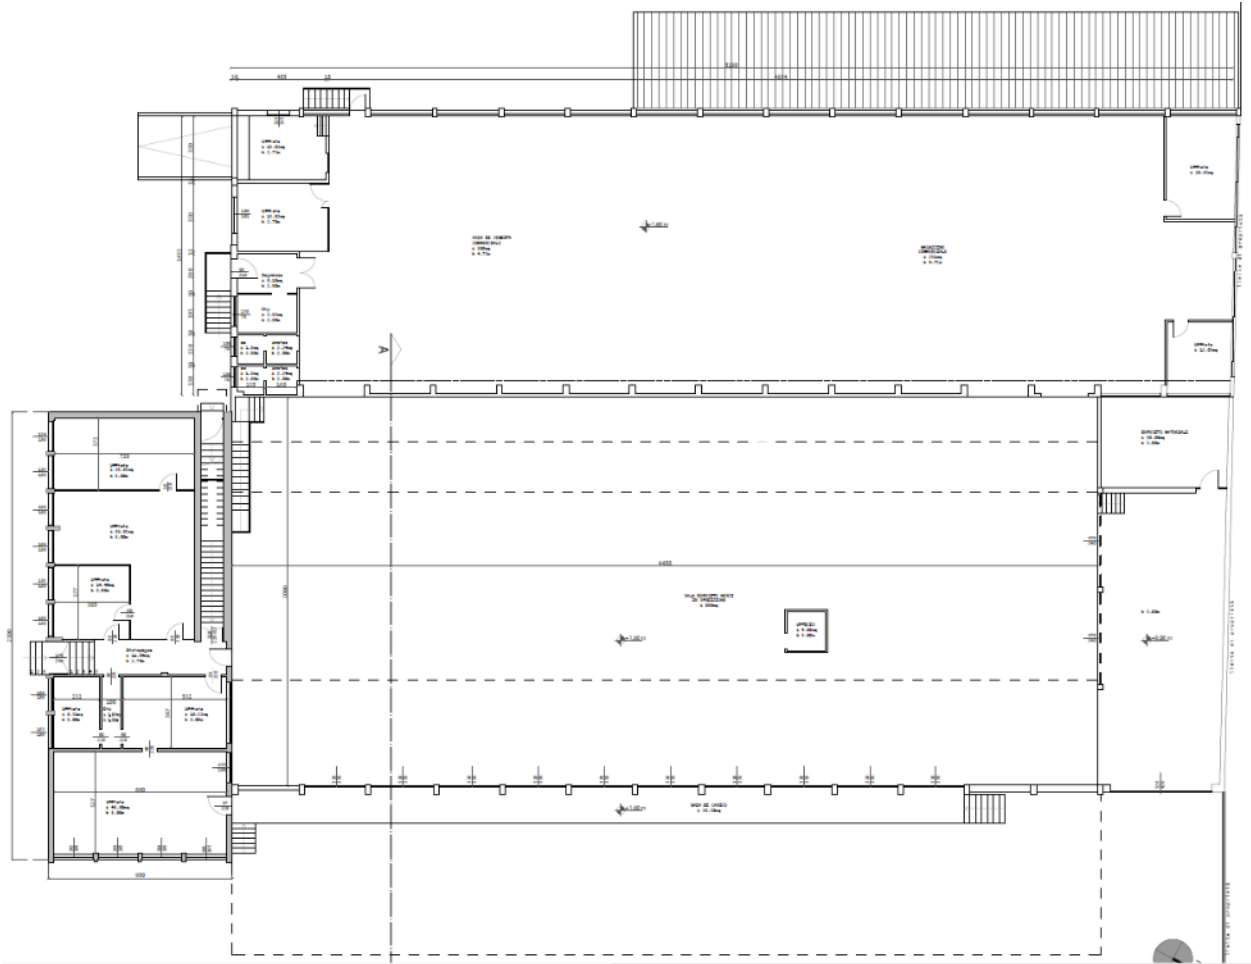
Stralcio elaborato T2 SDF-Pianta piano terra-rialzato stato di fatto
